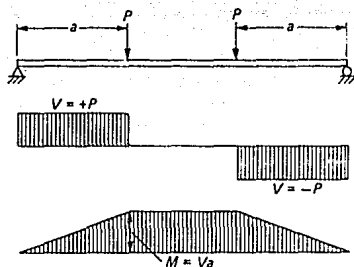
Claro de cortante en vigas (Ref. 6)
